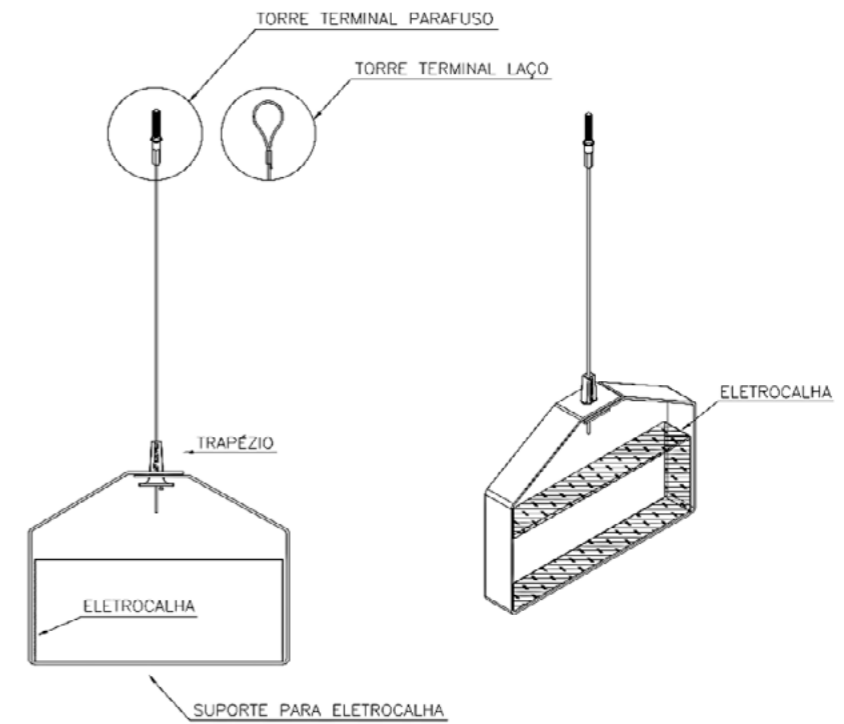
Modelo de fixação de eletrocalha em laje ou estruturas
